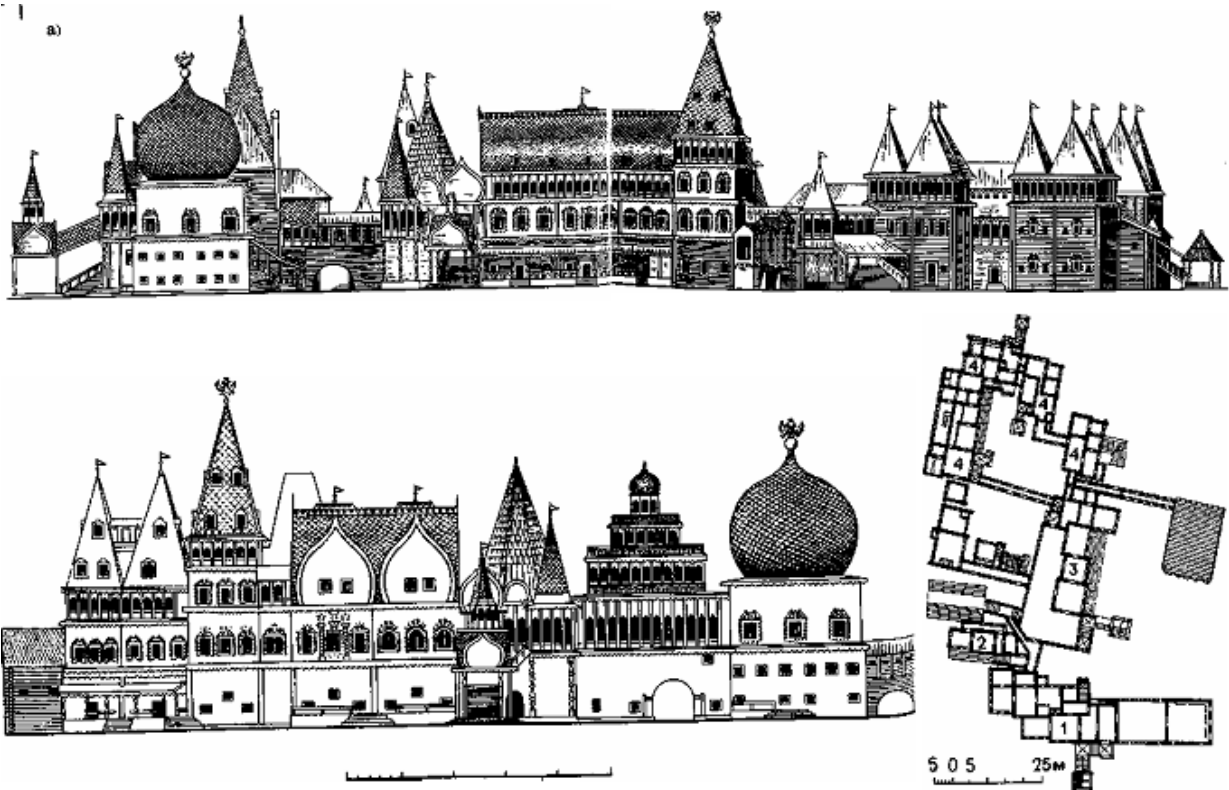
Народное деревянное зодчество. Дворец в Коломенском (1667—1681 гг.) близ Москвы. Фасады и план.
